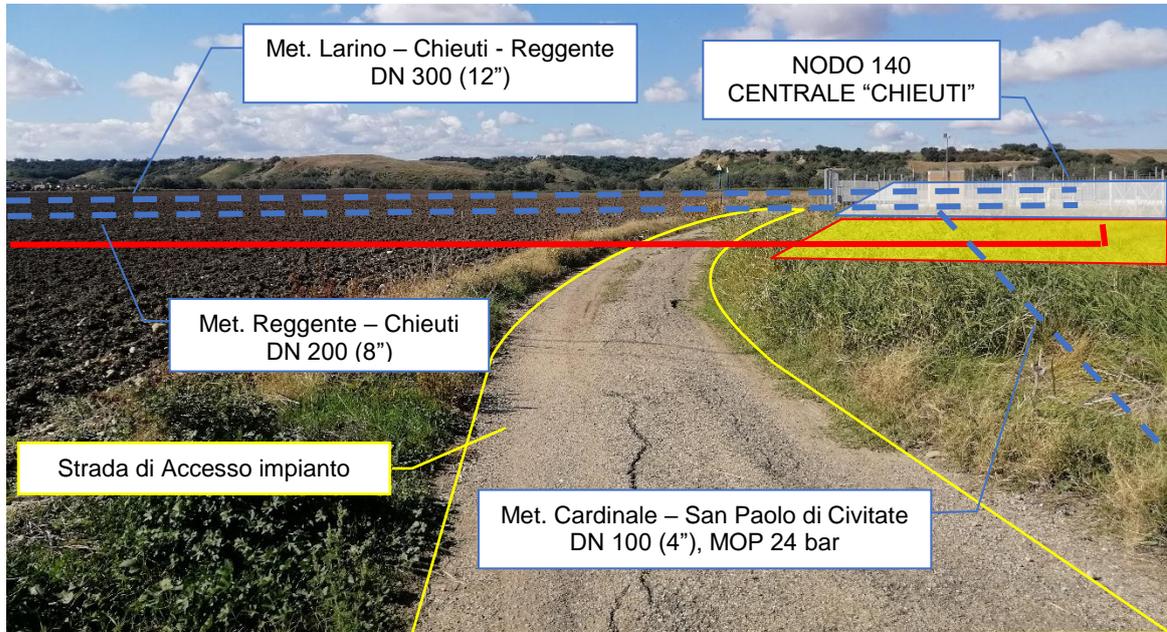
Attraversamento strada asfaltata a monte dell'impianto finale
